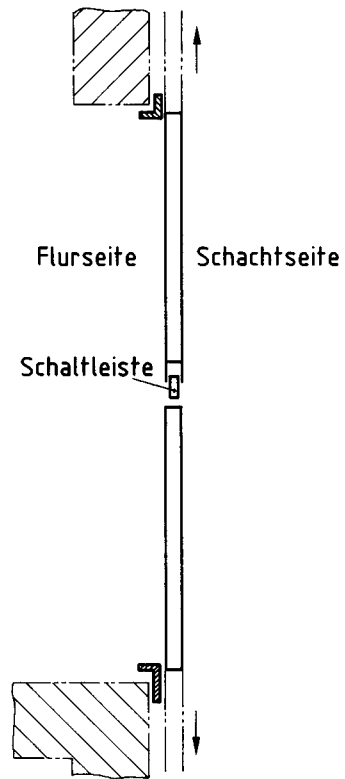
Horizontal bewegte, mittig öffnende, vierblättrige (Teleskop-) Schacht-Schiebetür
